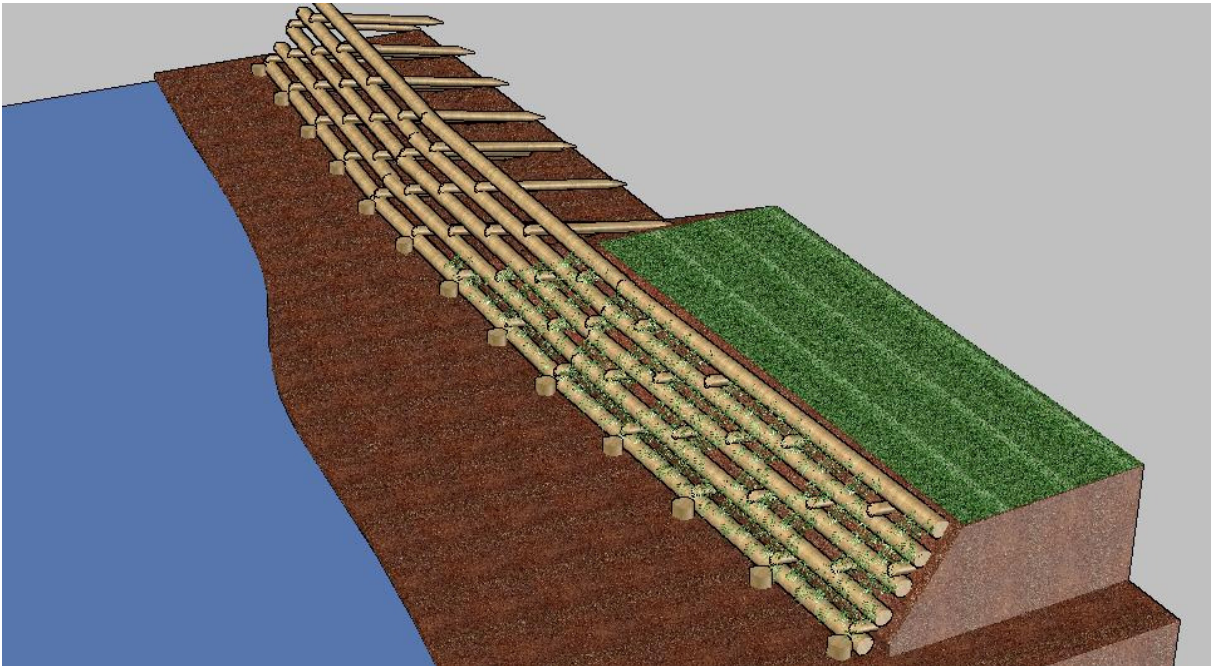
Vista tridimensional da parede Krainer observada a partir da ponte de acesso ao parque da CACISM.
